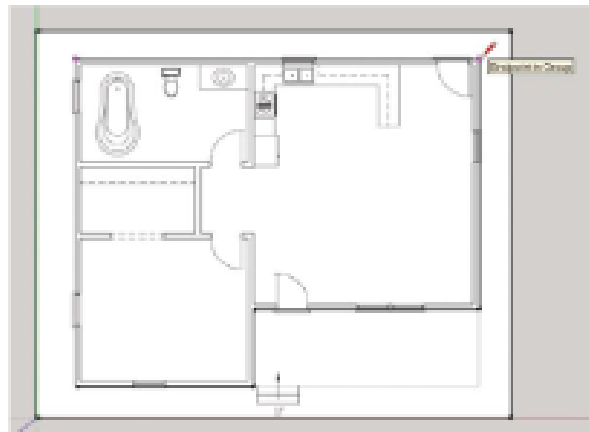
Klik Ikon Plan Pada Menu Views Untuk Menampilkan Denah Dalam 2D.
